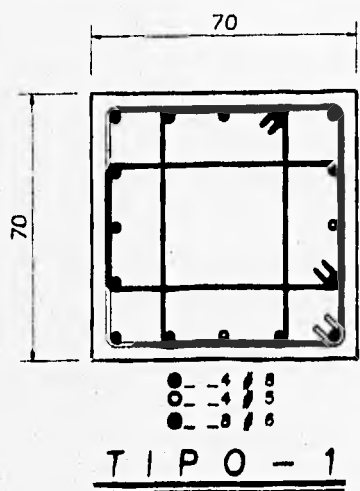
ARREGLO DEL REFUERZO LONGITUDINAL Y TRANSVERSAL EN COLUMNAS, MODELO 1, Q=2
